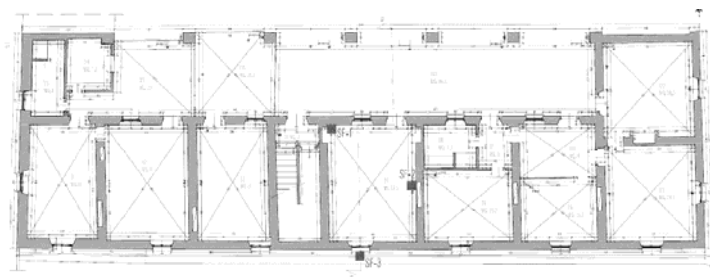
Localizzazione in pianta dei saggi effettuati sulla fondazione.
